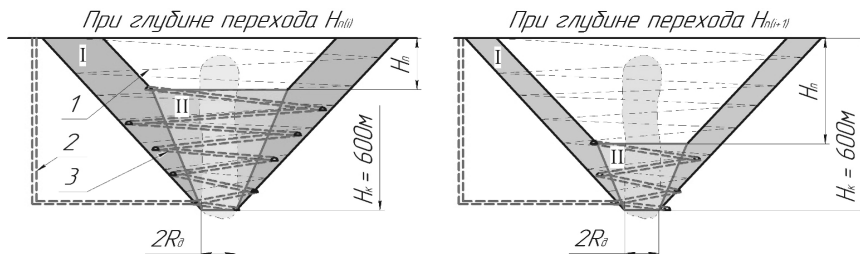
Варианты схем вскрытия глубоких горизонтов карьера: I — вариант доработки карьера традиционной схемой вскрытия с использованием автотранспортных съездов; II — вариант доработки карьера схемой вскрытия с использованием законтурных тоннельных съездов; 1 — транспортные съезды; 2 — вентиляционный ствол (скважина); 3 — тоннельные съезды; H_n — глубина перехода, м; H_k — конечная глубина разработки карьера; R_d — радиус дна карьера
